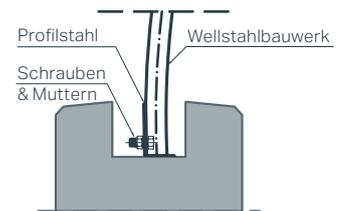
Weitere Verbindung der Stahlfertigteilkonstruktion mit Betonstreifenfundamenten
